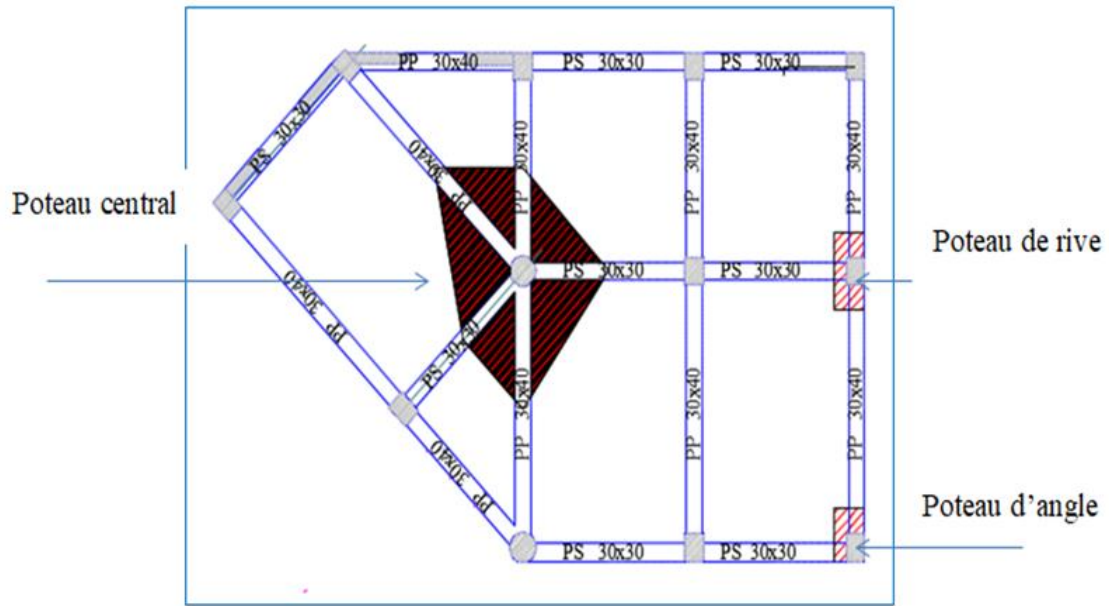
Les poteaux plus sollicités (central ; de rive et d'angle)
